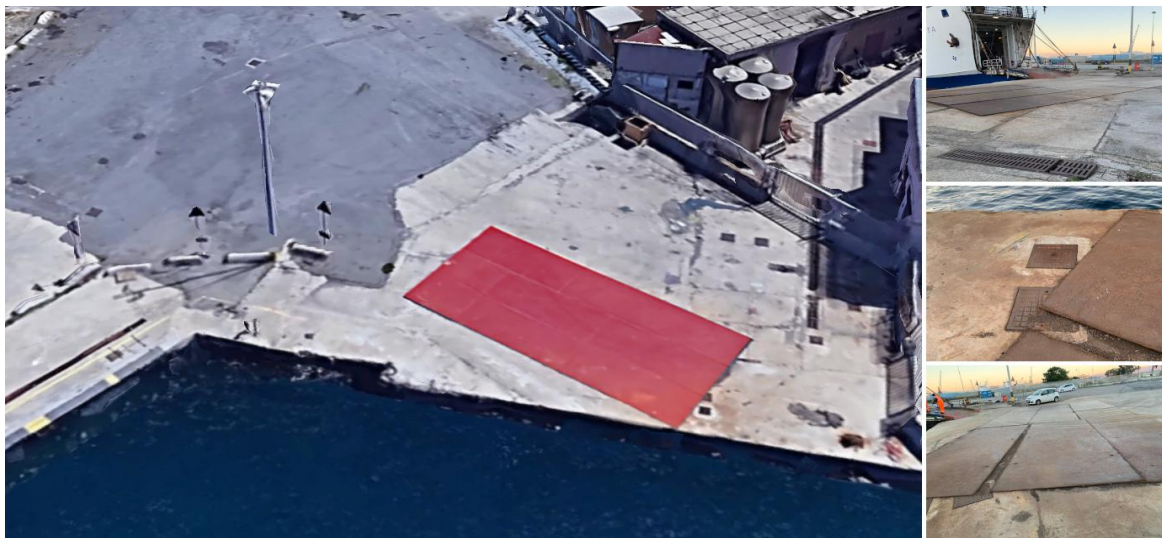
Area di intervento con in evidenza la piastra in acciaio e foto di dettaglio
